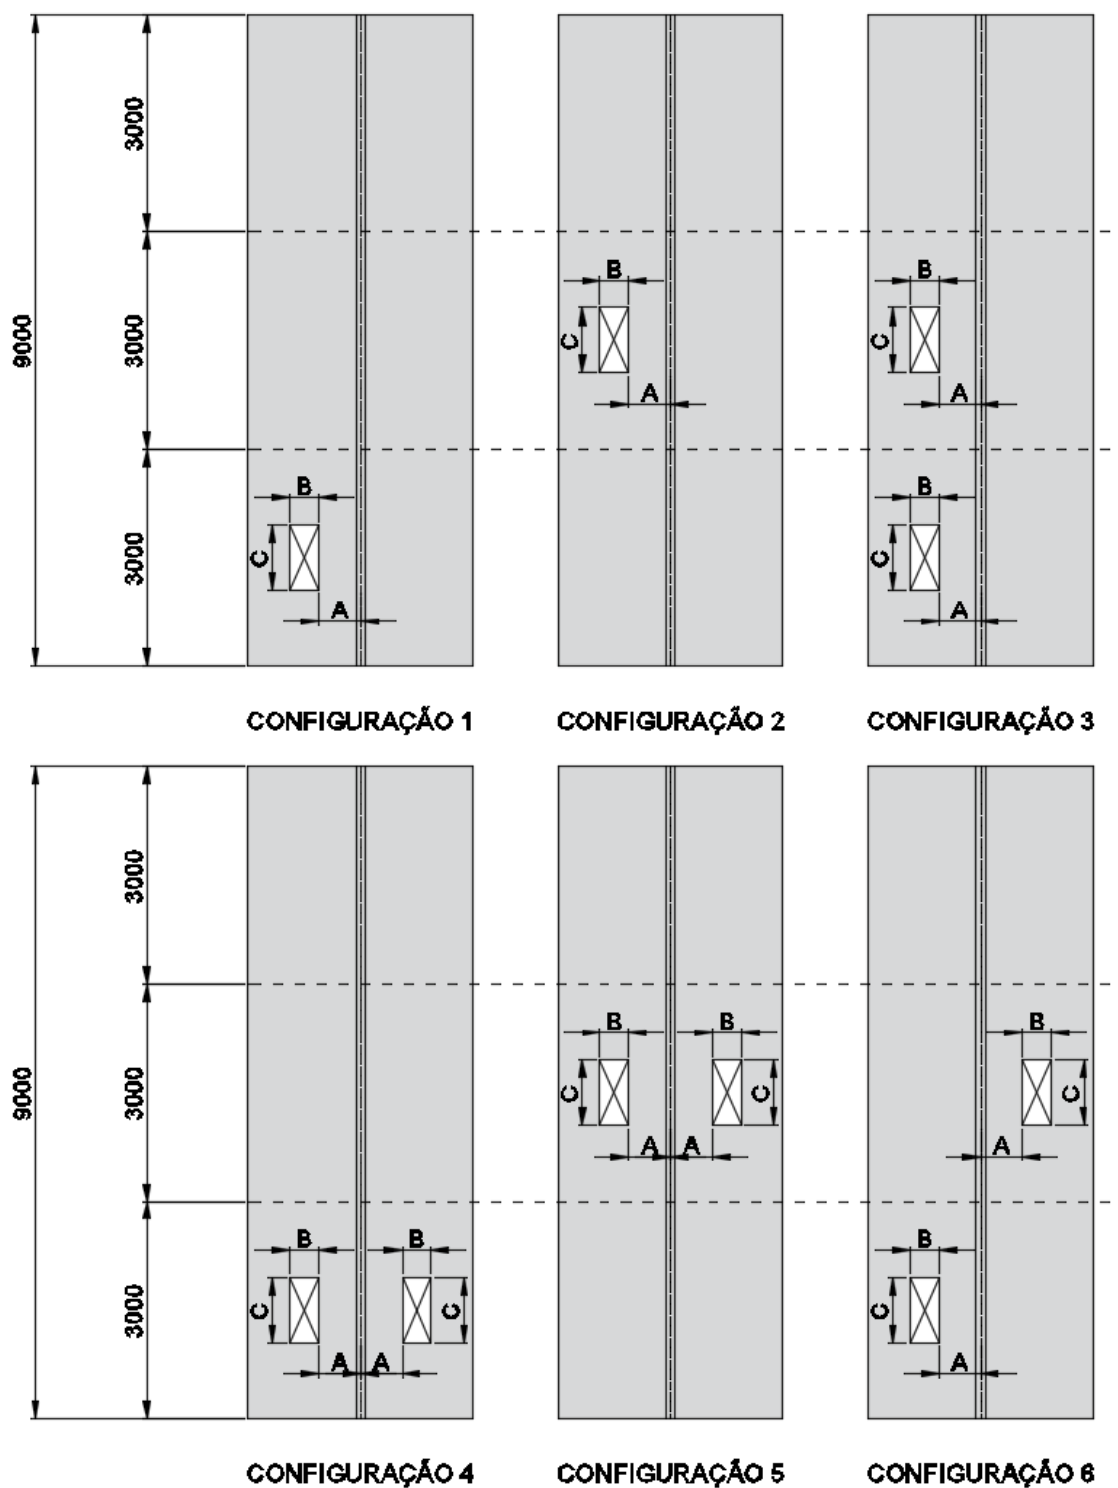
Configurações adotadas das aberturas na laje.
